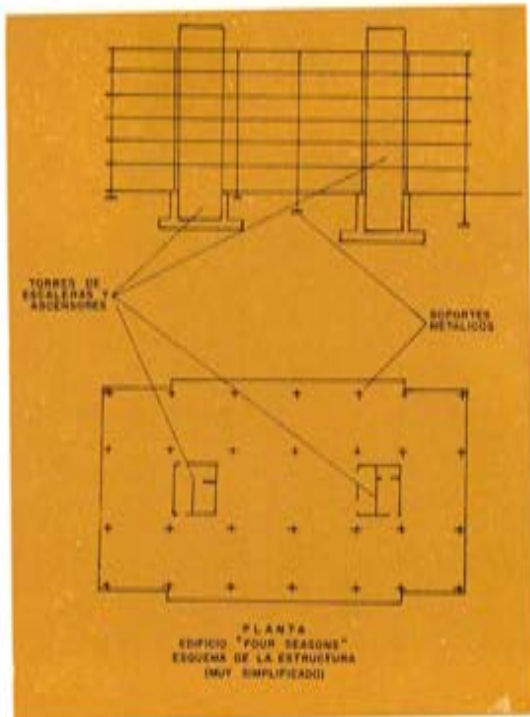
Anchorage (Four Seasons Building): Esquema de la estructura.
